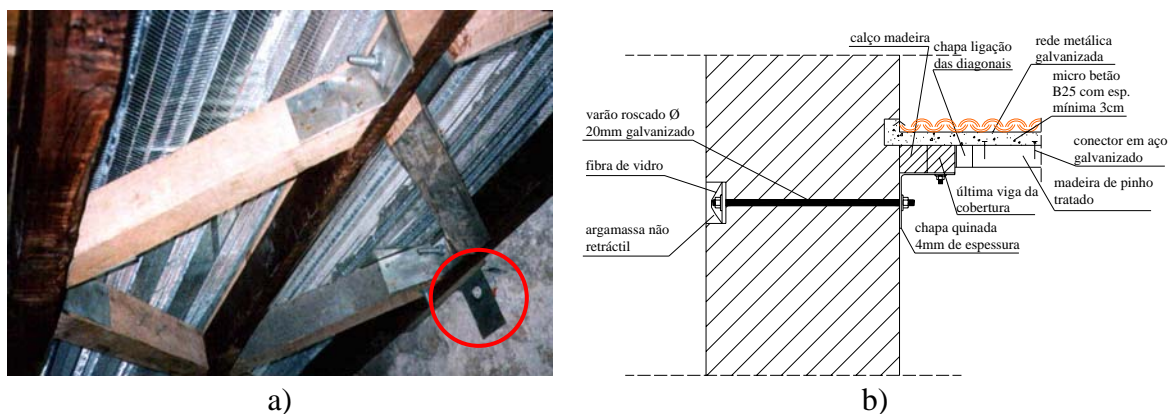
a) [4e] Estrutura em treliça e chapa amarração à fachada
